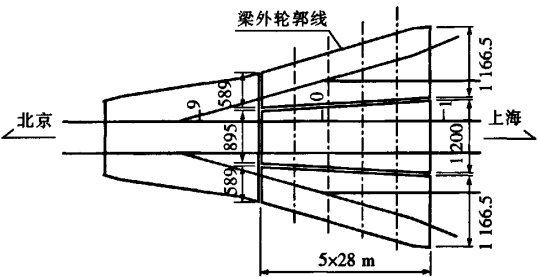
到发线道岔区 5×28 m 三幅桥方案孔跨布置平面图
